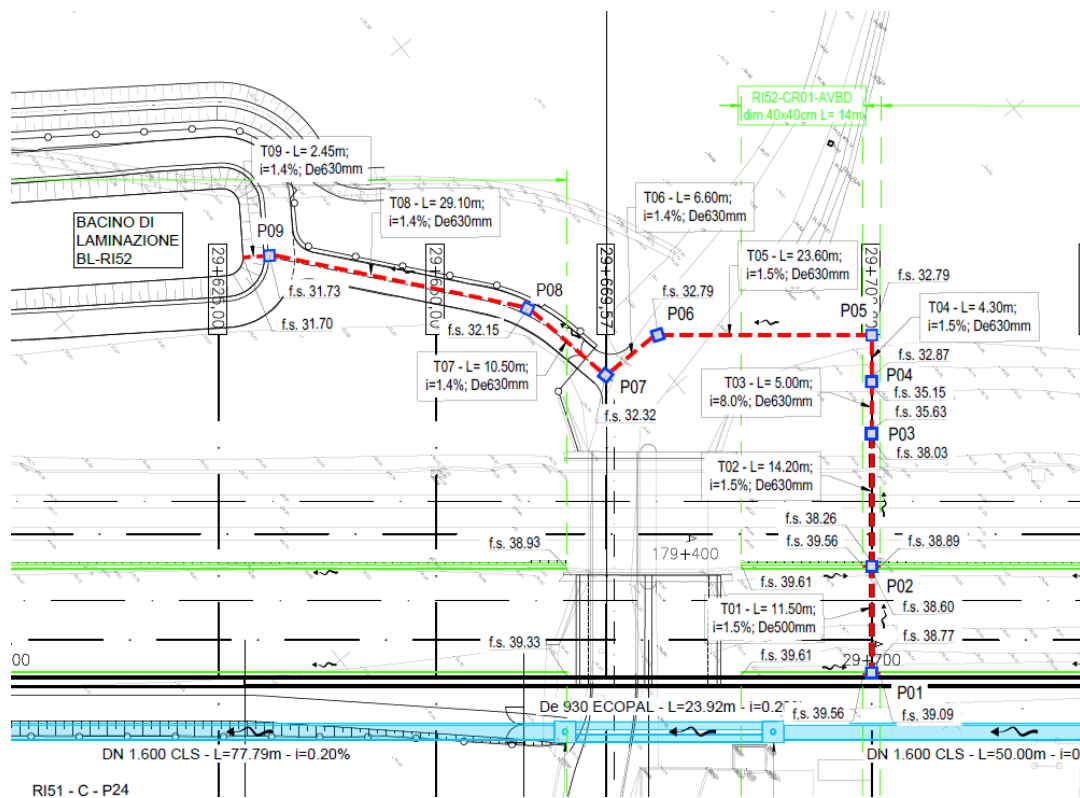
Stralcio planimetrico di scarico dalla piattaforma al BL
